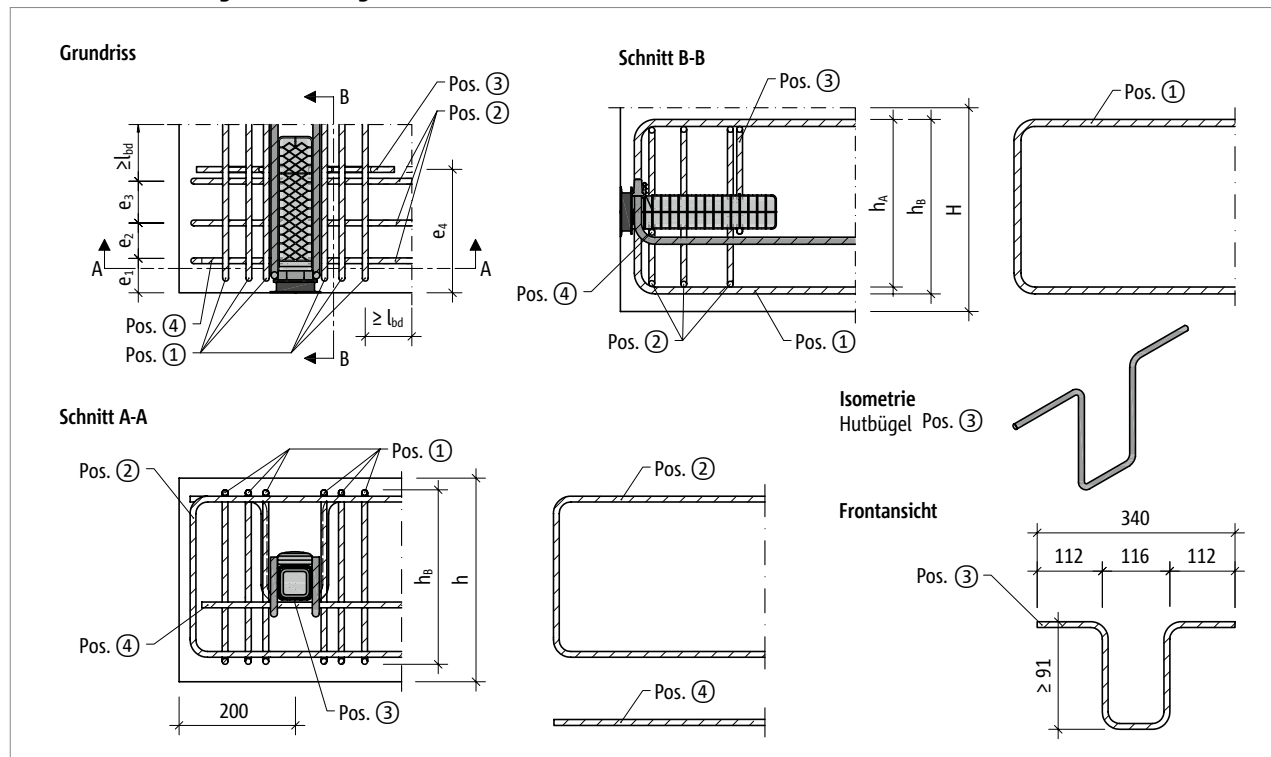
Schöck Tronsole® Typ P: Bauseitige Bewehrung
